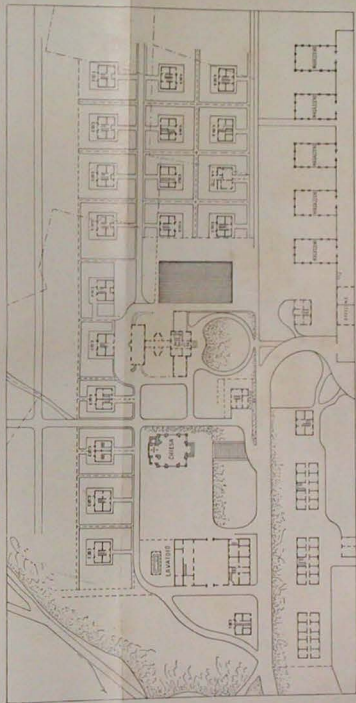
Pianta del villaggio Crespi sull'Adda.
